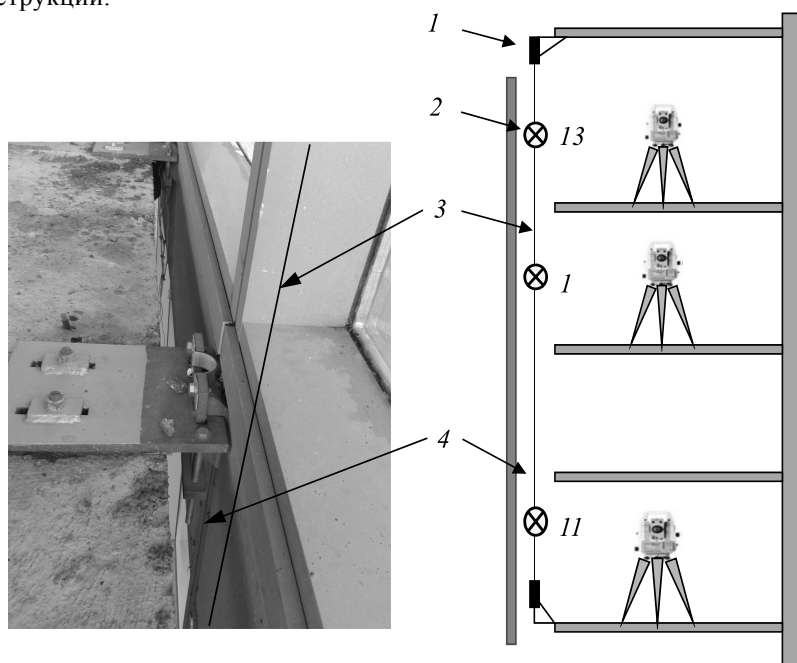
Размещение оборудования при замене штанги проволокой: 1 – динамометр и устройство крепления проволоки; 2 – пластиковый отражатель; 3 – проволока; 4 – отверстие между стеклопакетами фасада и плитой перекрытия
